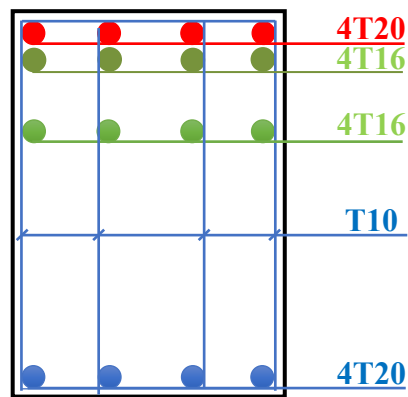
Ferrailage de la poutre de libage (sens transversal)
